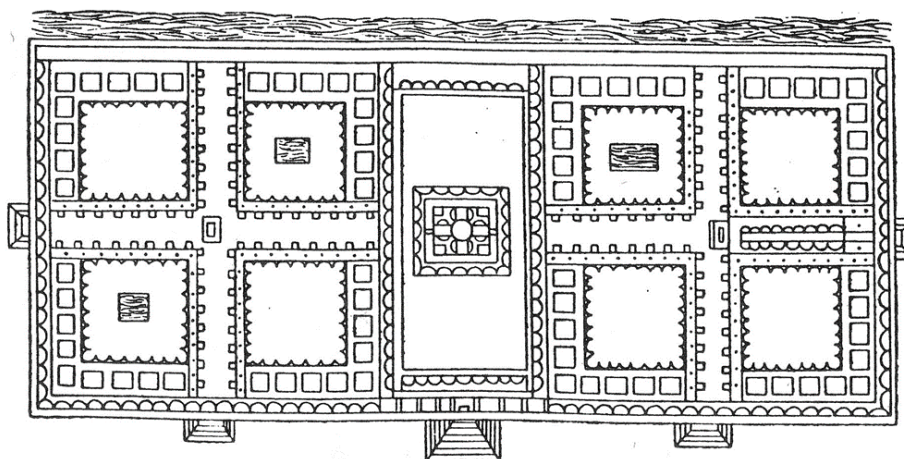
Pianta dell'Ospedale disegnata da Filarete, 1456
